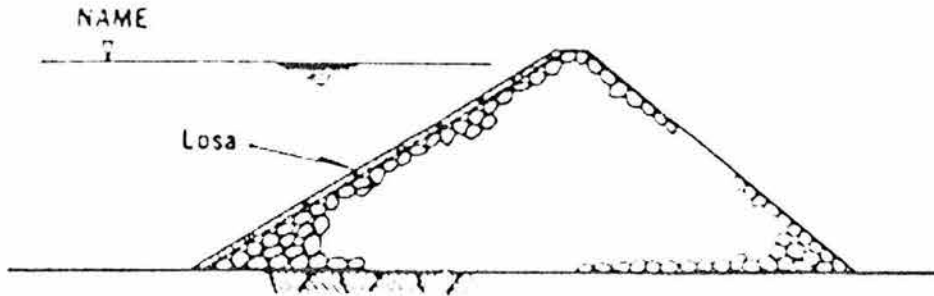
Presa de enrocamiento con losa o asfalto (cimentación rígida)
